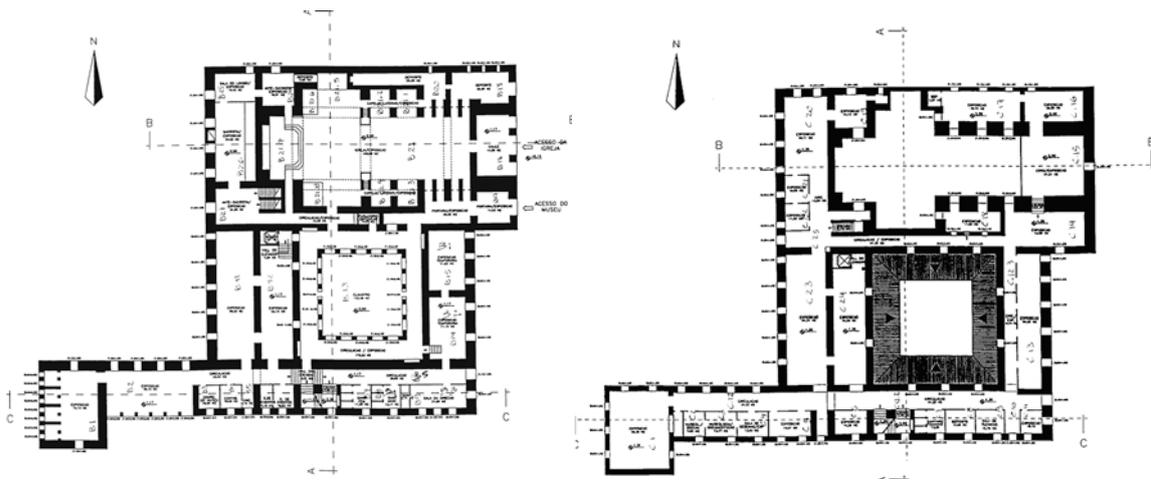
Plantas baixas dos níveis 2 e 3 do Convento e Igreja de Santa Teresa – MAS.
